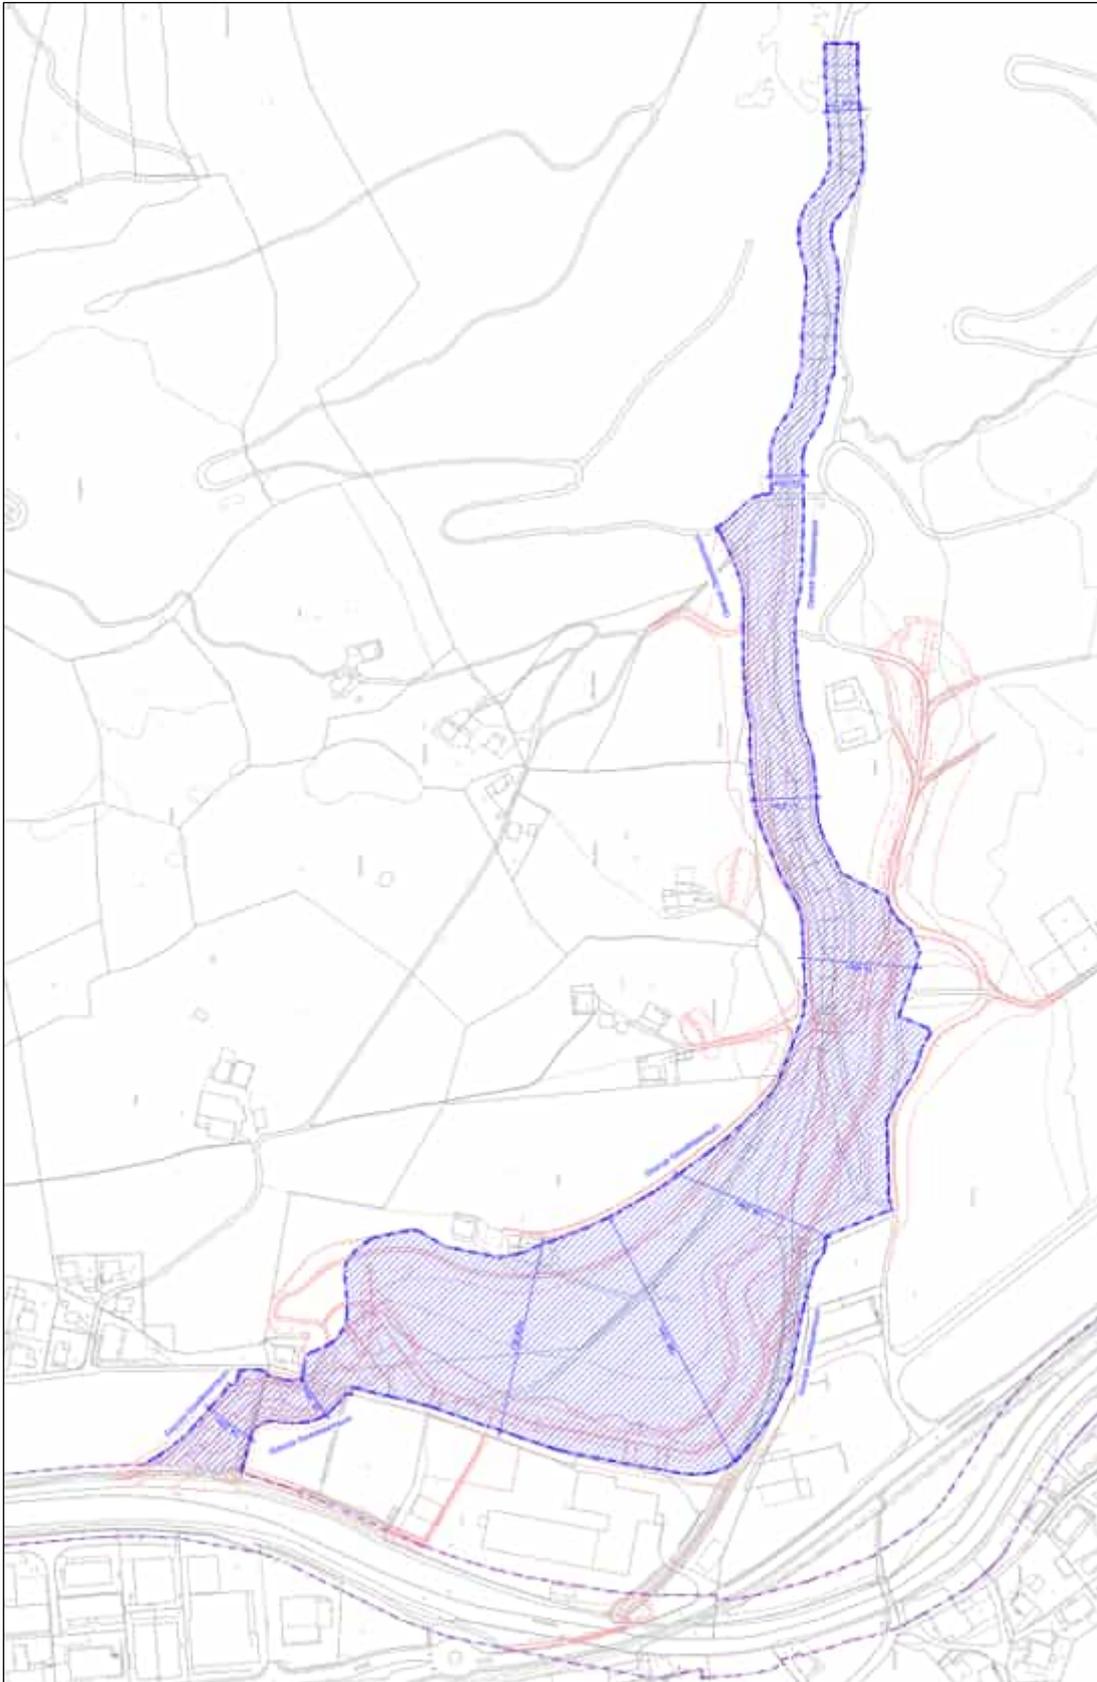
Umsetzung minimale Gewässerraumbreiten (Auflageprojekt (Plan 2287-402b, Schubiger AG, 2024)
